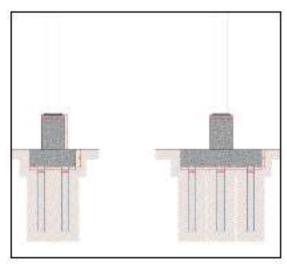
Esquemes Piles 1/3 i Pila 2 - Central
